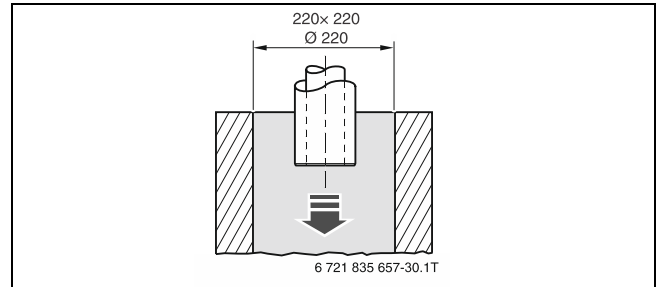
Минимальные размеры поперечного сечения шахты для монтажа воздуховода (размеры в мм)
